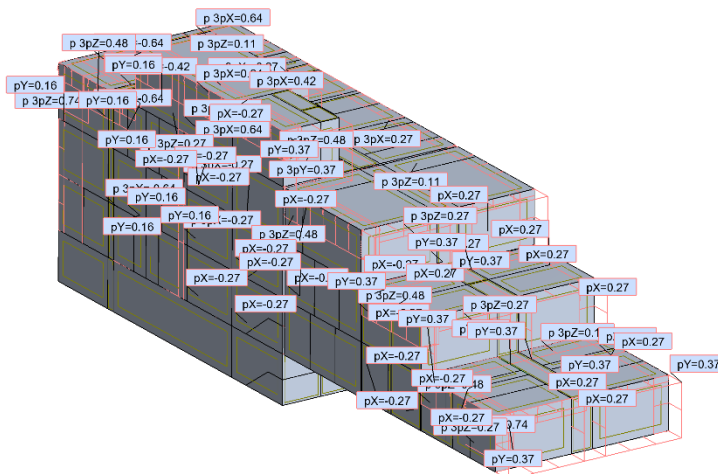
Przypadek obciążenia od wiatru 1 na konstrukcję
